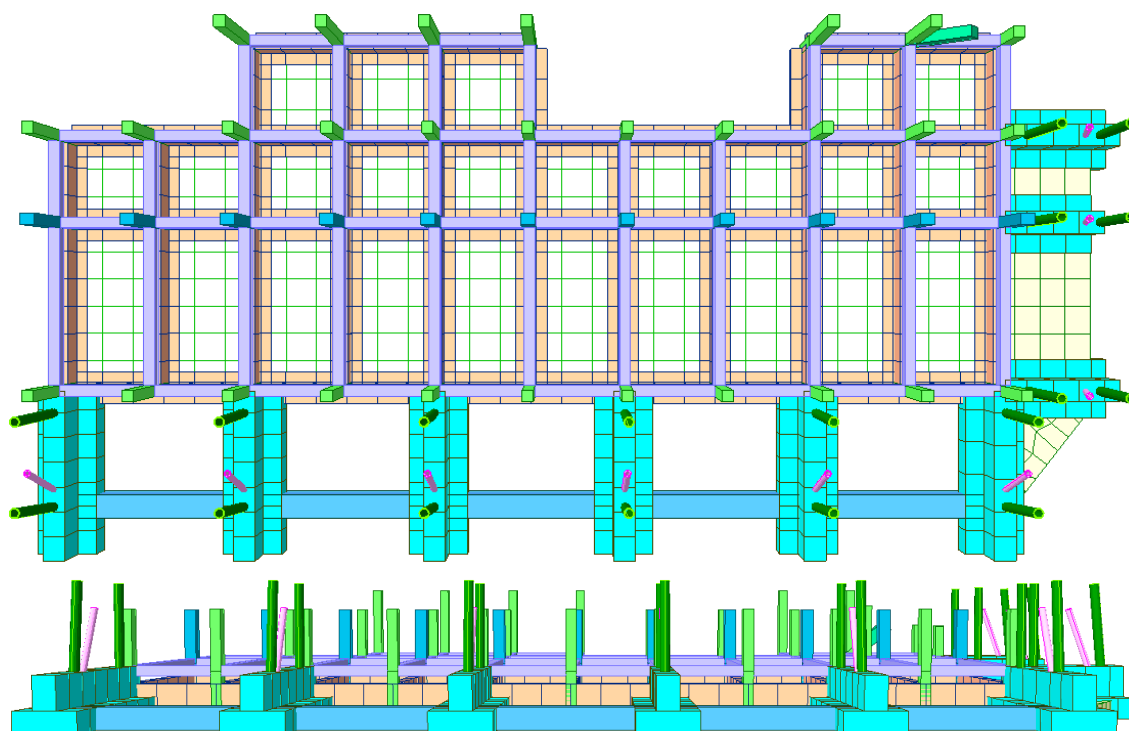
INSERIMENTO SISTEMA DI FONDAZIONE NEL MODELLO FEM DEL BLOCCO B: VISTA IN PIANTA (PIANO XY) E FRONTALE (PIANO YZ)
